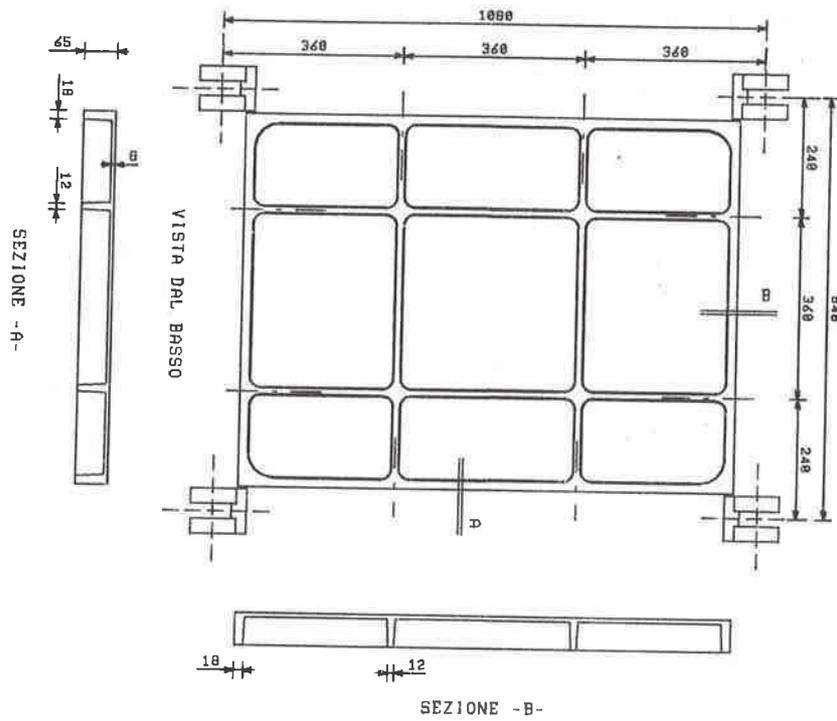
pianta e sezioni di una piastra di dimensioni 10.80x8.40x0.65
